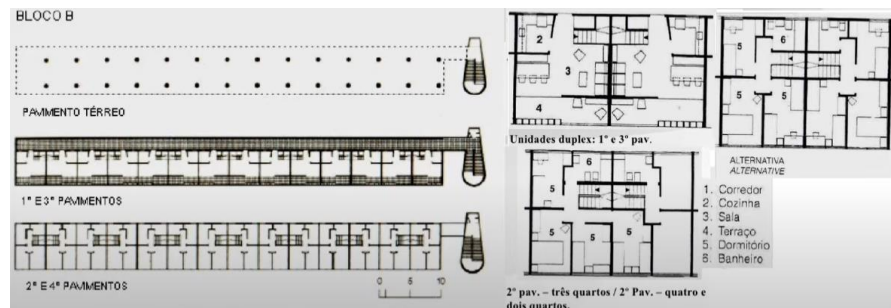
Conjunto Pedregulho: Planta baixa dos apartamentos do bloco B. Fonte:
